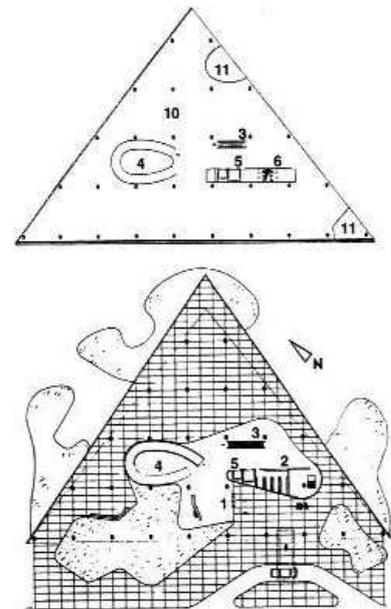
Museu de Artes Visuais de São Paulo, Afonso Eduardo Reidy, 1952. Planta do térreo (embaixo) e 1º e 2º pavimentos (acima).
